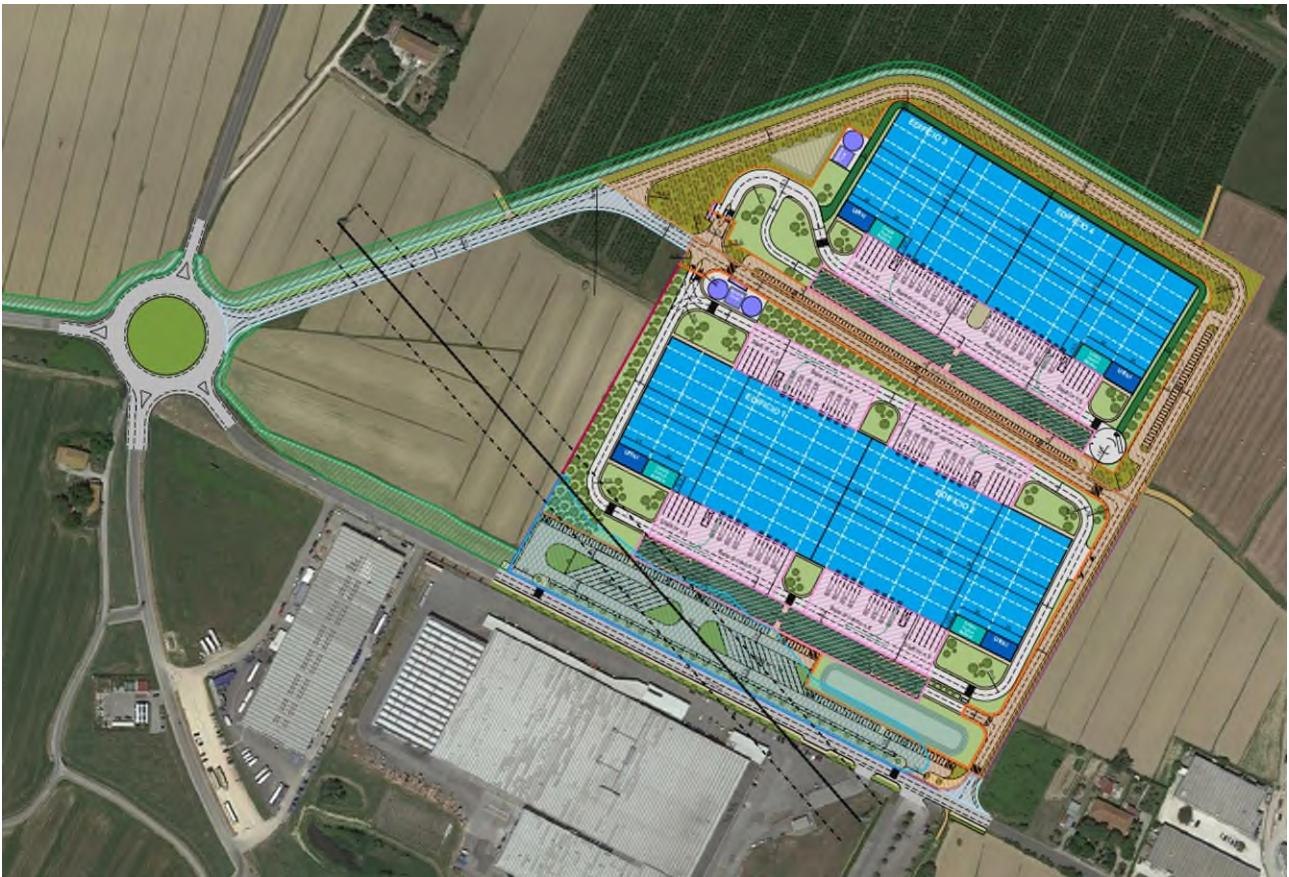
Planimetria di progetto dell'intervento e sistema di accesso
